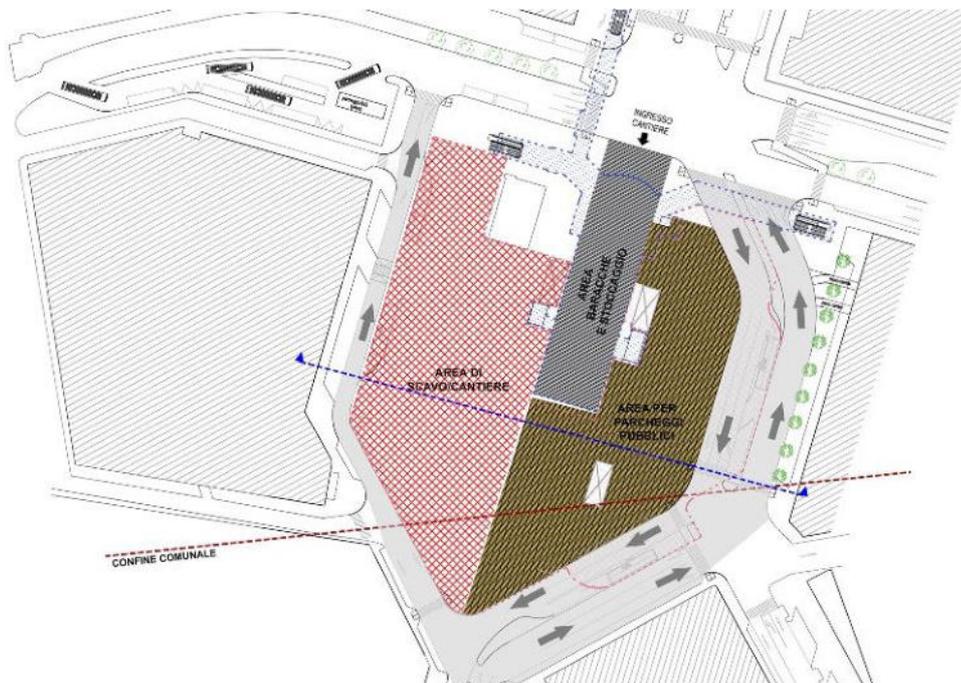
Pianta e sezione dell'organizzazione di layout per la Fase 2
